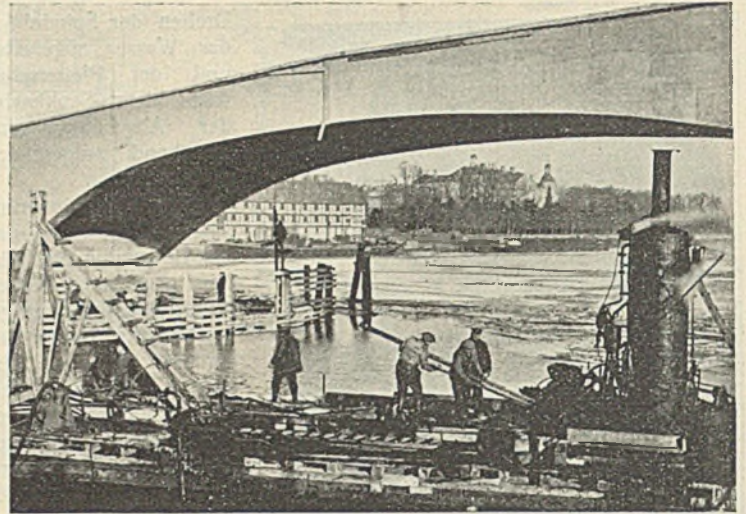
Ausgeschaltete rechte Öffnung, links Kämpferrahmenbalken. Ziehen der Lehrgerüstpfähle, im Hintergrunde Schloß und Speicher.
